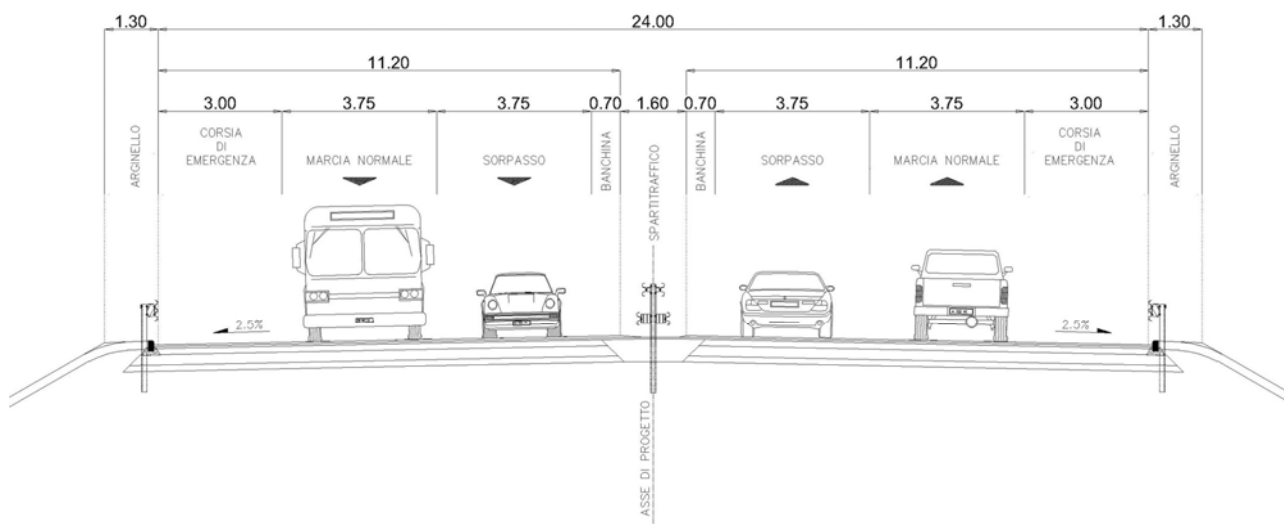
Sezione tipo di progetto (tratto di adeguamento Variante SS1 Aurelia)
